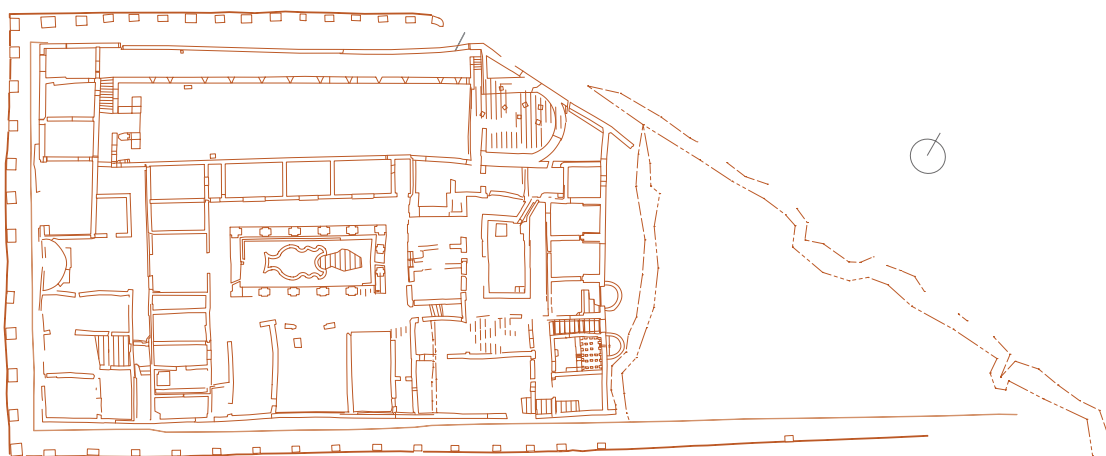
Plano del estado actual de la Casa de la Exedra (fuente: R. Angulo, 2009. *Elaboración de las fichas diagnóstico de los bienes inmuebles del CAI*)
